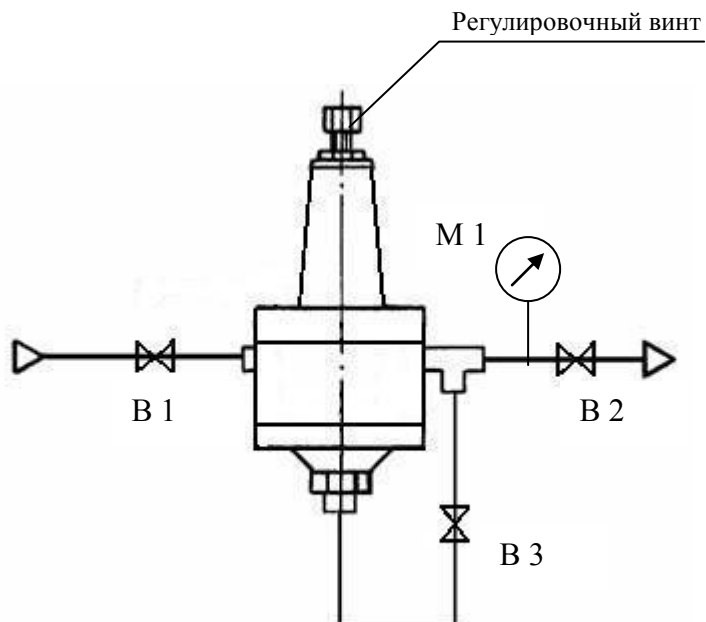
Схема установки регулятора типа РДС-ПС-05
